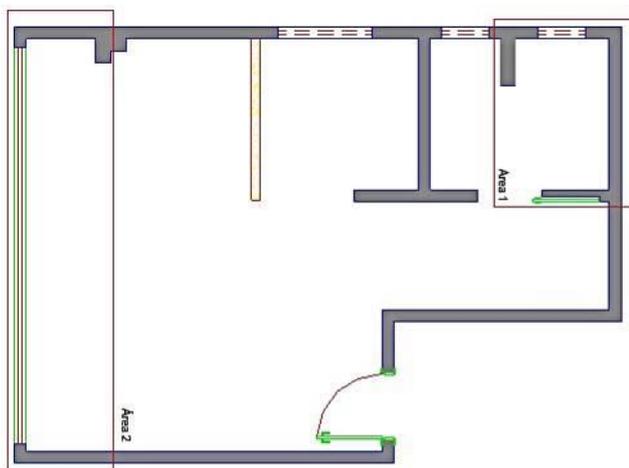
Elemento Estrutural e detalhe do local da inspeção na laje do Pavimento Superior.
